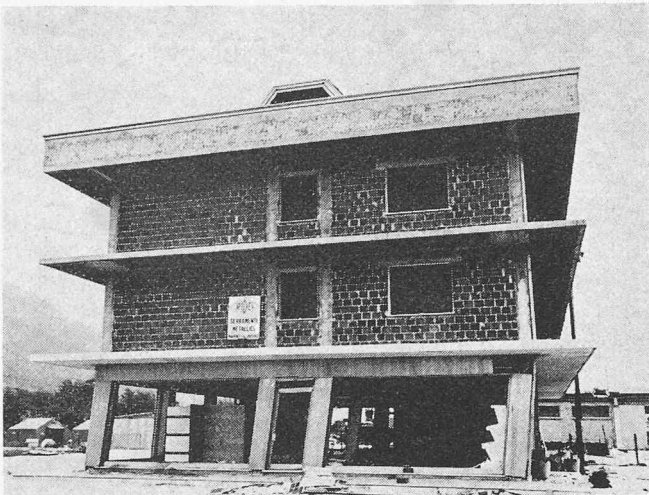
Wohnhaus mit Verkaufslokal bei Artegna. Stahlbetonskelettbau mit Backsteinfüllwänden in den Obergeschossen, im vorne offenen Erdgeschoss ist nur die hintere Längswand und das Treppenhaus ausgefacht. Die Drehbewegung des Gebäudes wurde durch die versteifende Wirkung der Treppenhauswände verursacht
